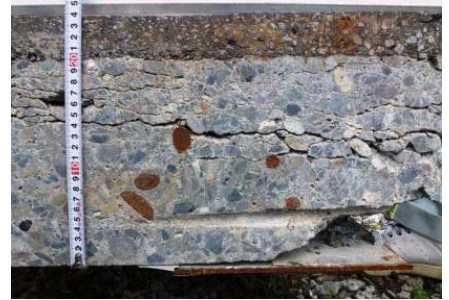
RC 床版内に発生した水平ひび割れ
